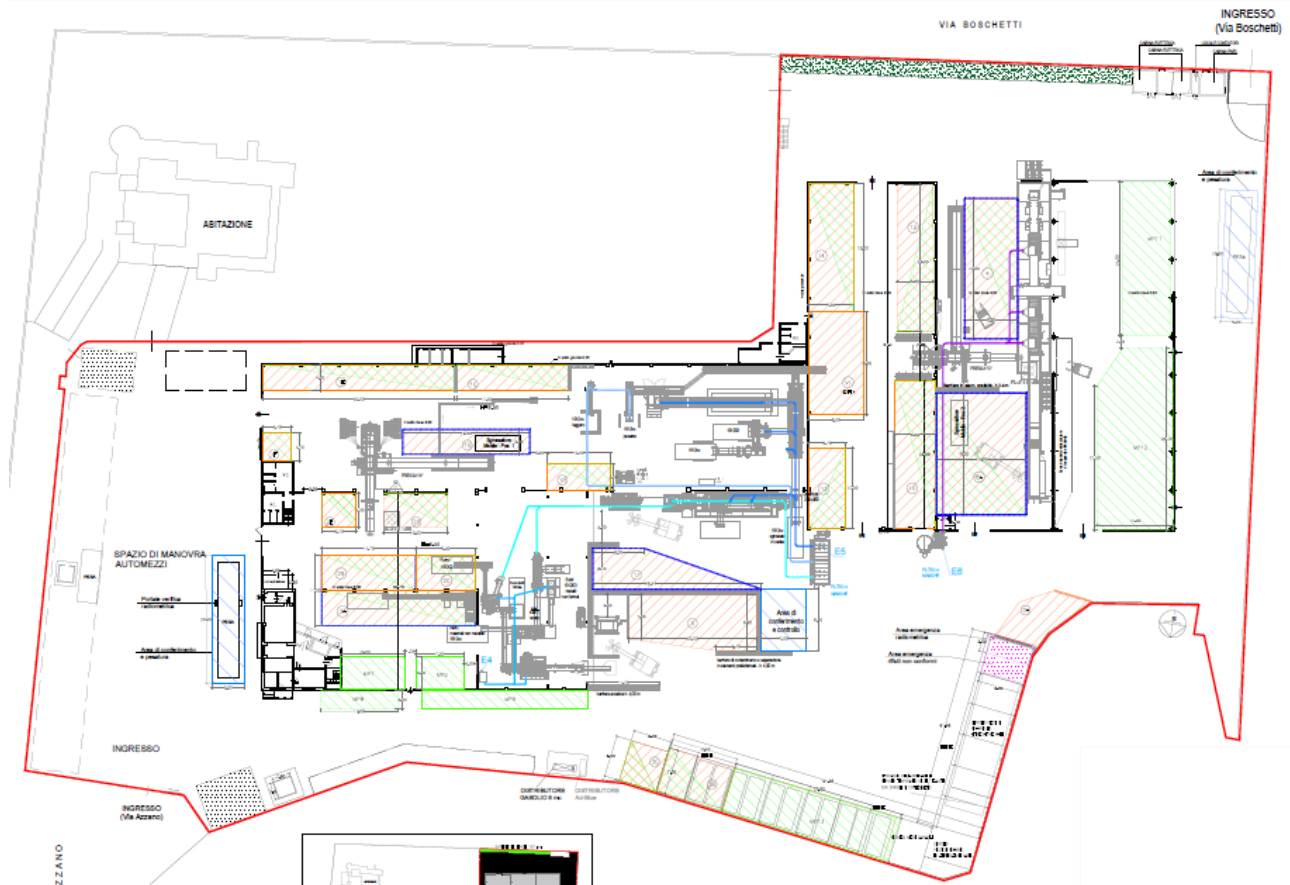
Nuova planimetria autorizzata dell'impianto
